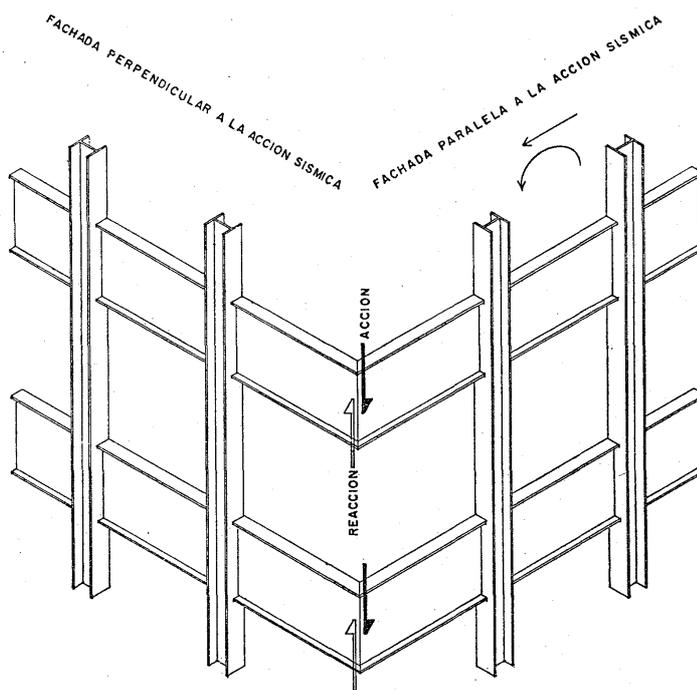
Efecto tubular en la esquina: Al actuar el sismo, en cada una de las esquinas del edificio, las vigas perimetrales transmiten a la correspondiente viga perpendicular fuerzas de corte verticales. Esa interacción hace trabajar a las cuatro fachadas conjuntamente, convirtiendo la simple acción de pórtico de cada cara del edificio en un conjunto tridimensional más efectivo.
